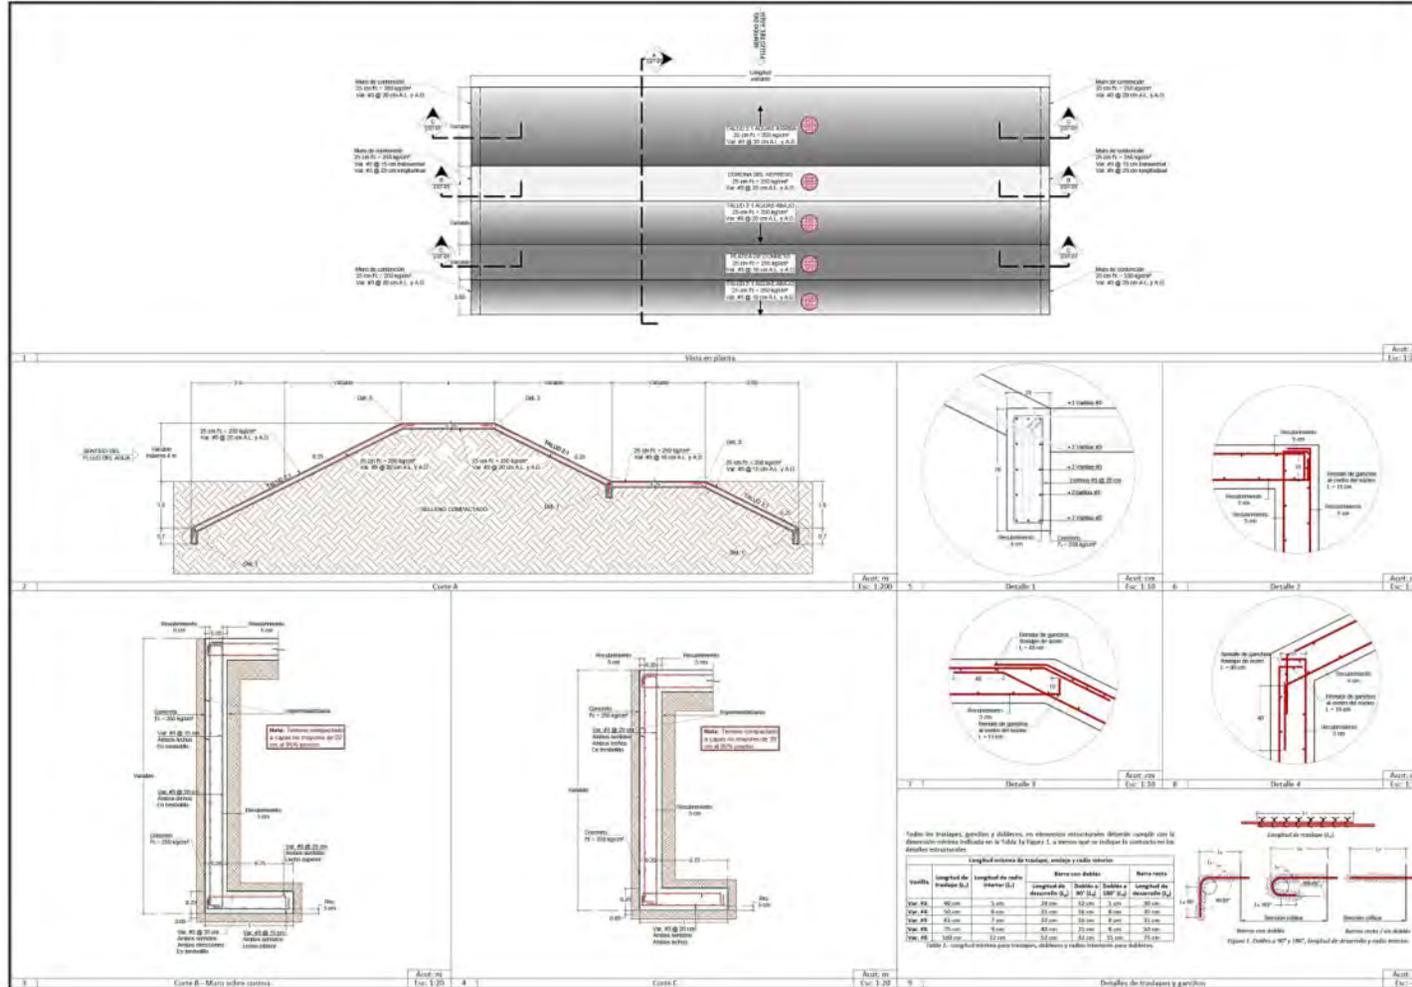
Detalles estructurales tipo para los bordos Q1 y Q2 del proyecto.
